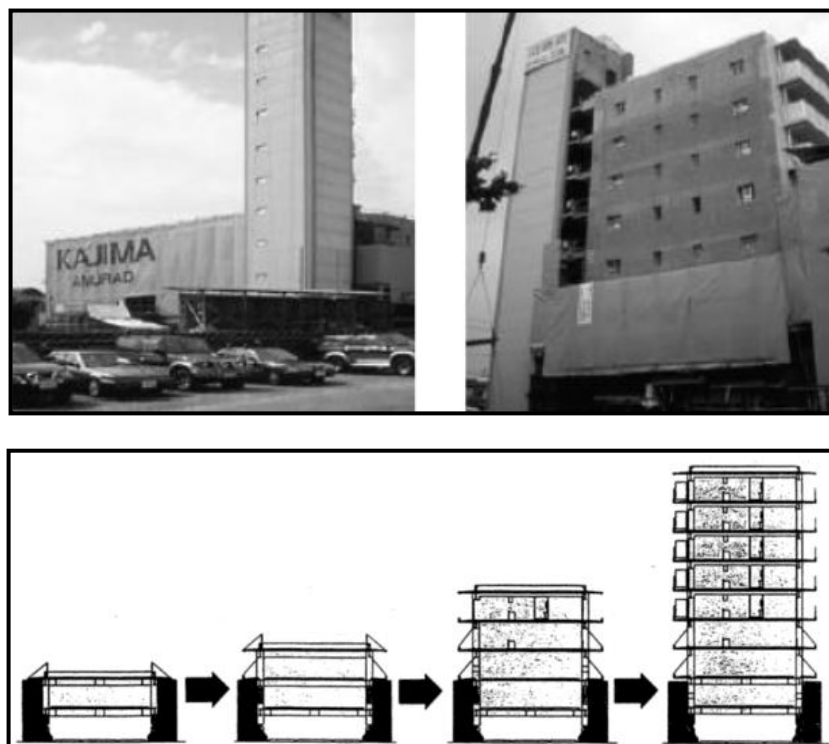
a) y 63 b) Evolución de la construcción en el sistema AMURAD. *Advanced Construction and Building Technology for society*.
